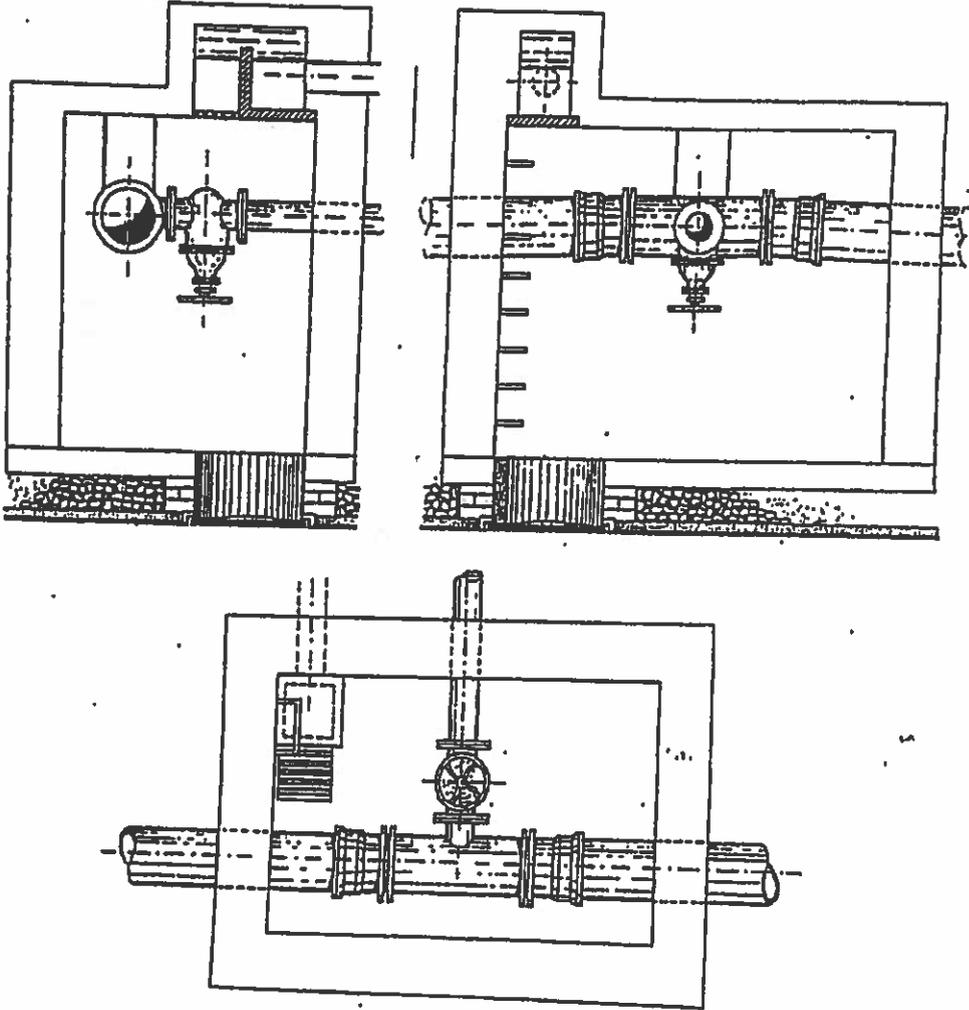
Pozzetti per gli sfiati delle tubazioni: pianta, sezione longitudinale e sezione trasversale.
